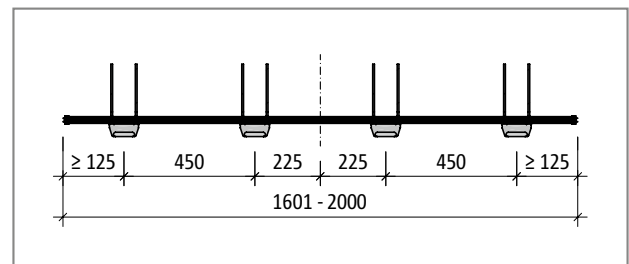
Schöck Tronsole® Typ T-V4-H...-L1601 bis L2000: Produktgrundriss
